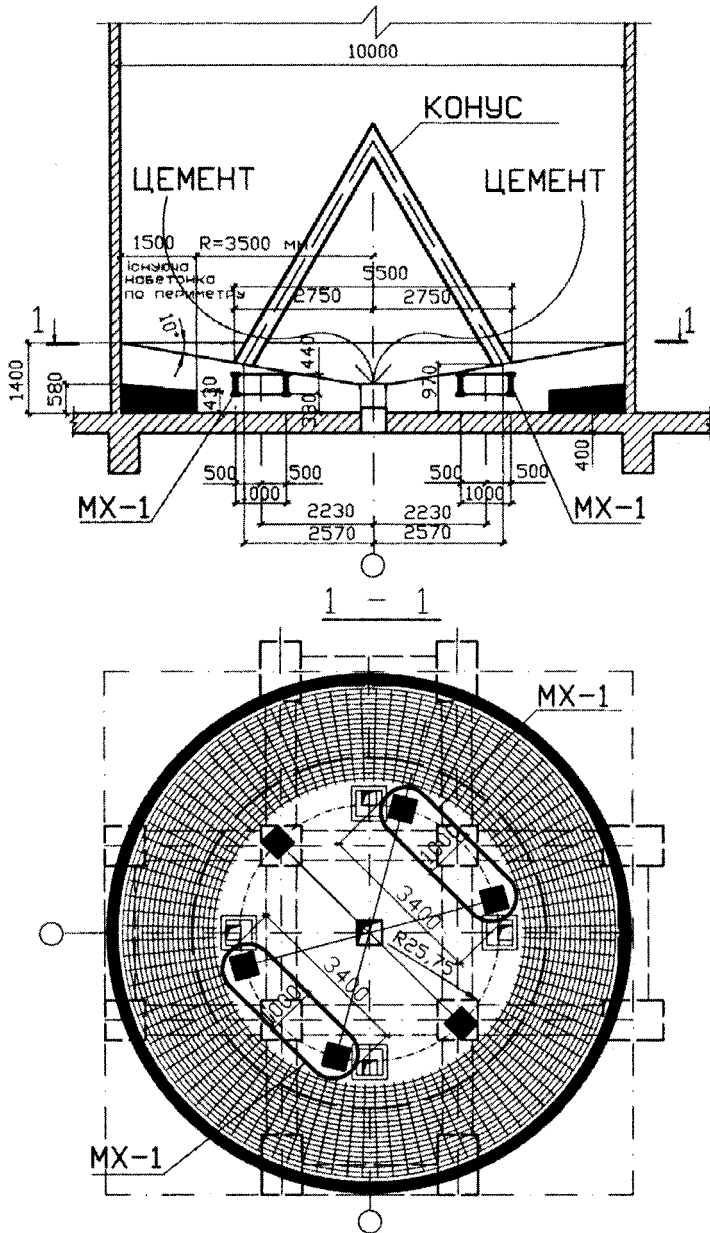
Схема розташування розподільчого металевого конуса для цементу, його опор, арматурних елементів MX-1 та кільцевих арматурних сіток у набетонці дна силосу
